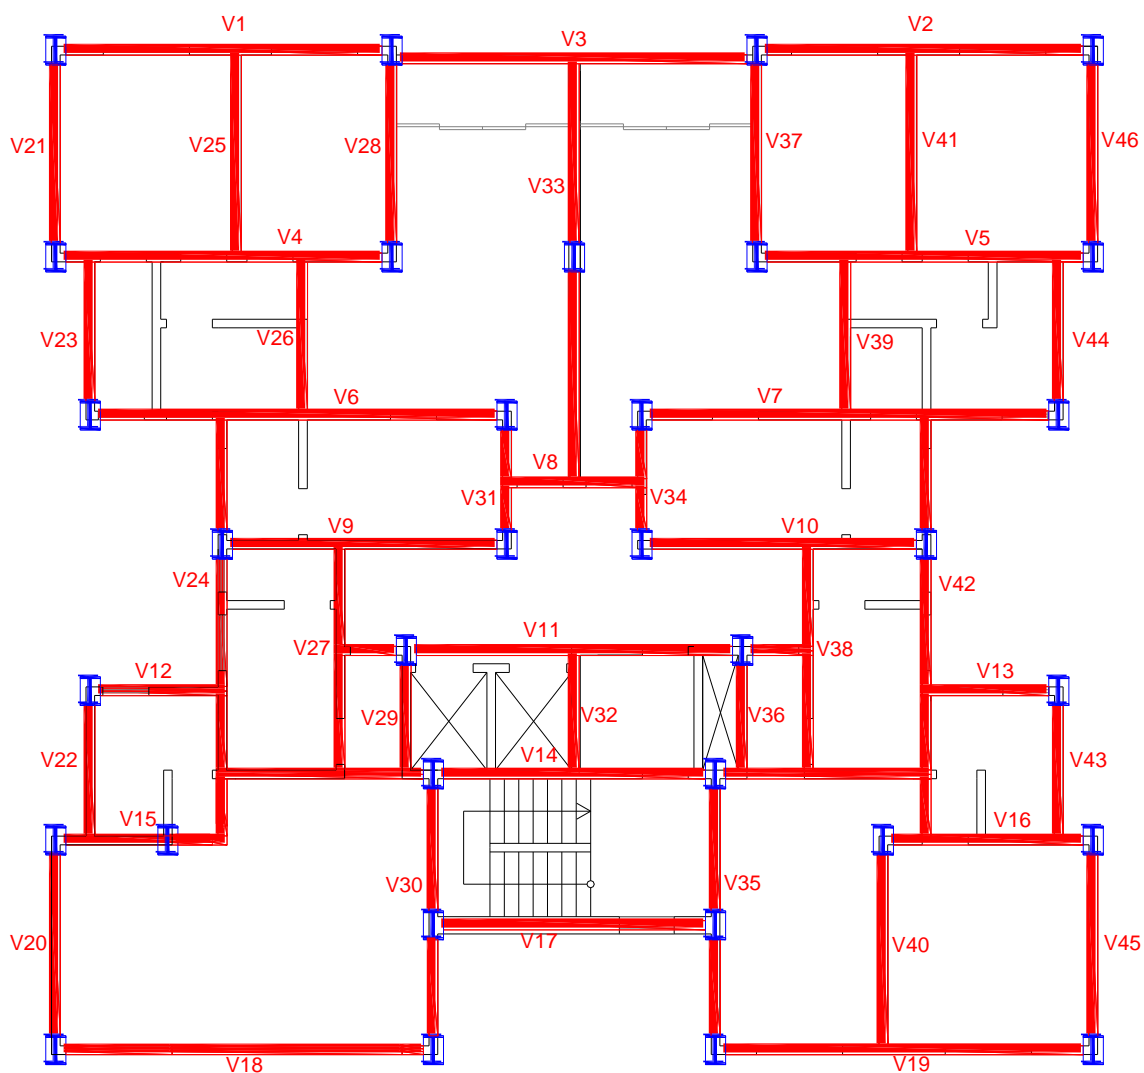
Localização dos pilares e das vigas em aço – Residencial Navarro.
